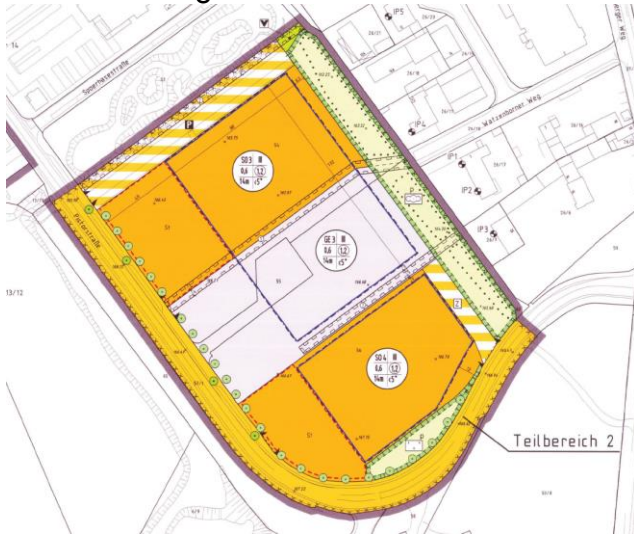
Planausschnitt Bebauungsplan GI 04/05 „Am Grüninger Pfad“, 1. Änderung
